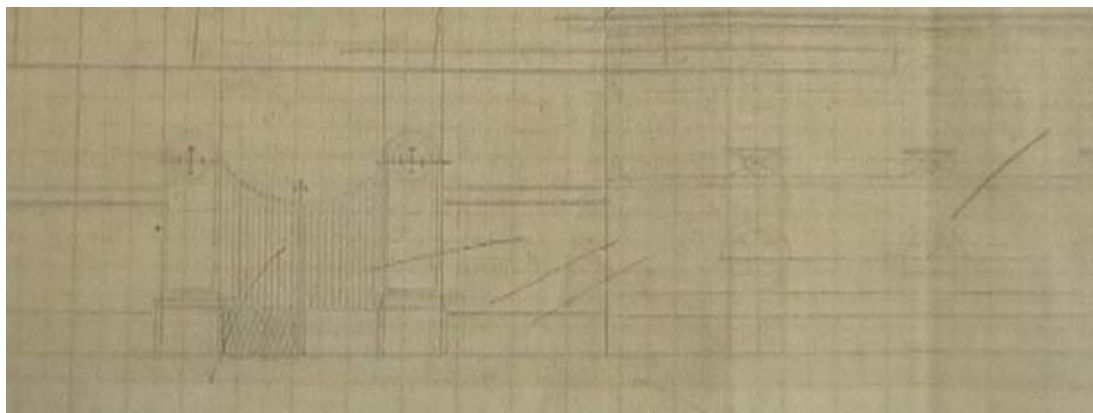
Entrada del cementerio en el primer proyecto. Carlos Mancha
